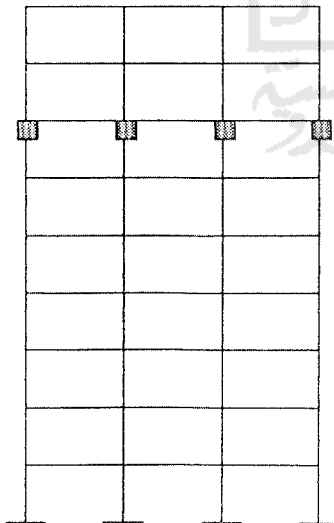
Tingkat 9 lantai ke 4
